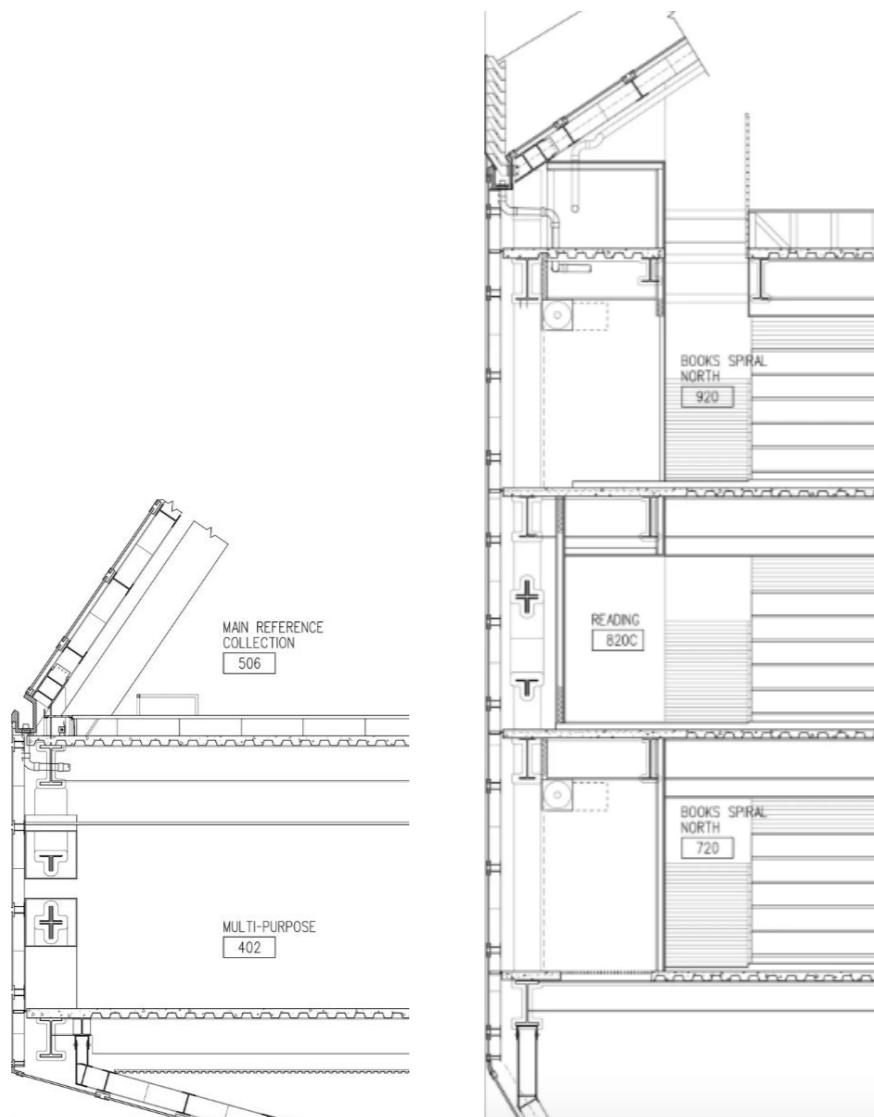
Corte Construtivo entre o 4º e o 5º Piso.
